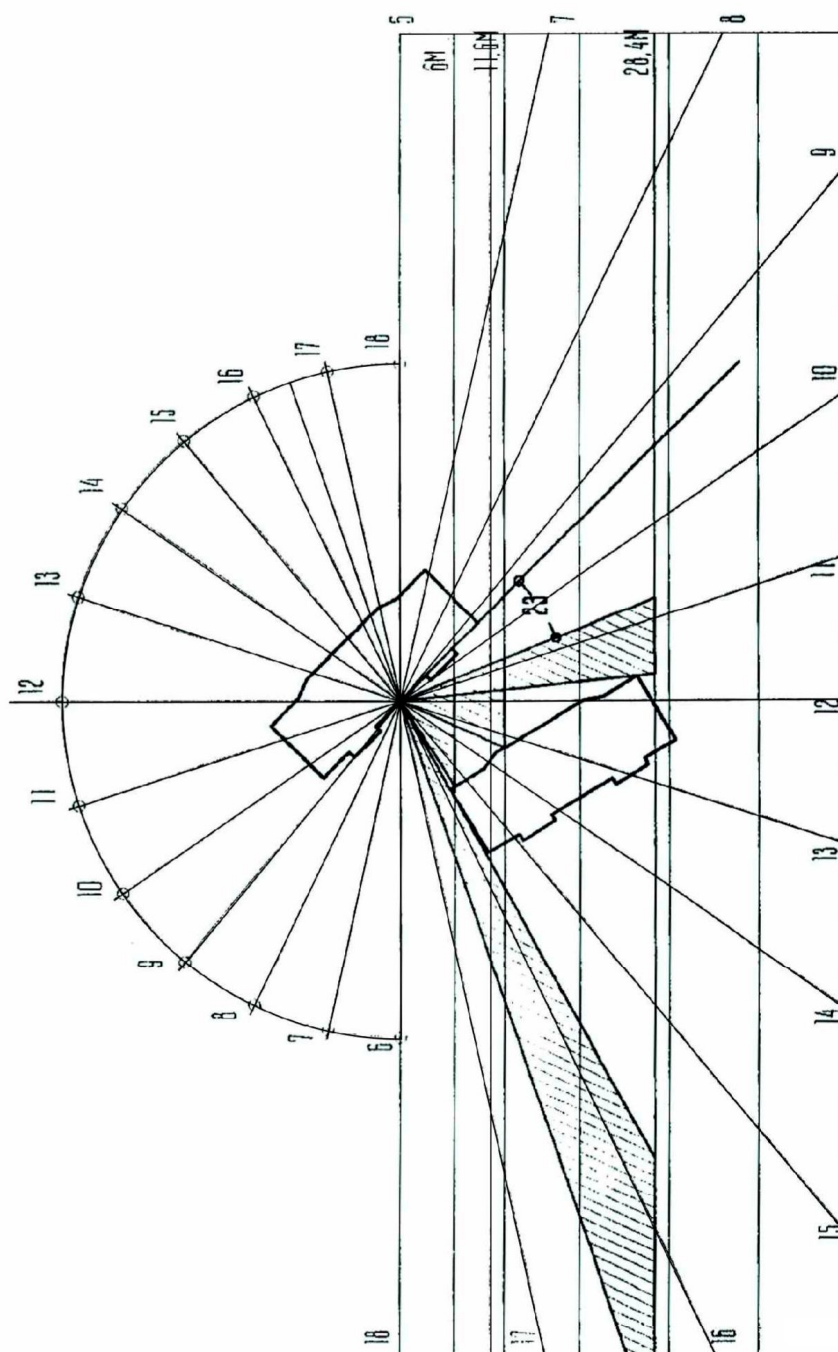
Расчет времени инсоляции точки фасада на уровне 8-го этажа с учетом затеняющего здания
